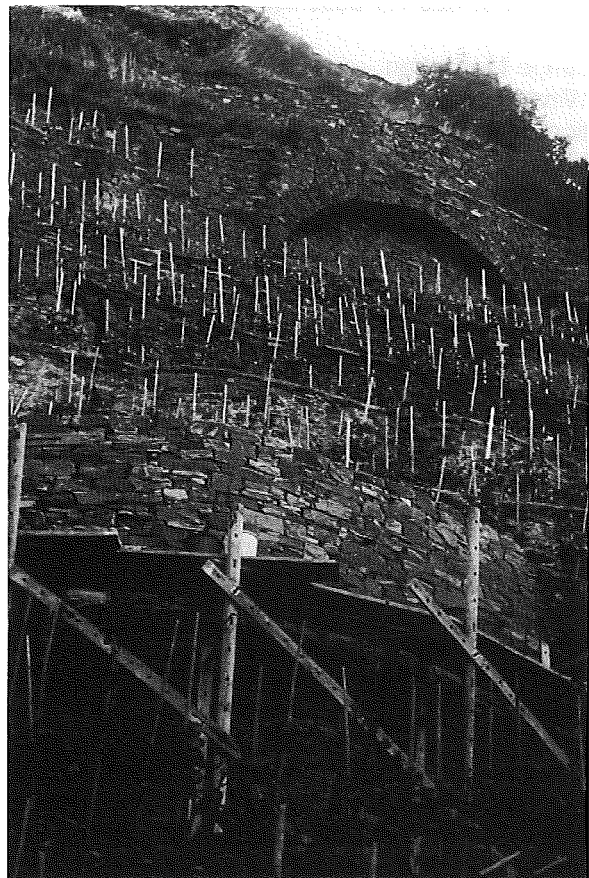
Mauersanierung mit Bruchsteinen in Trockenbauweise nach traditioneller Bautechnik
